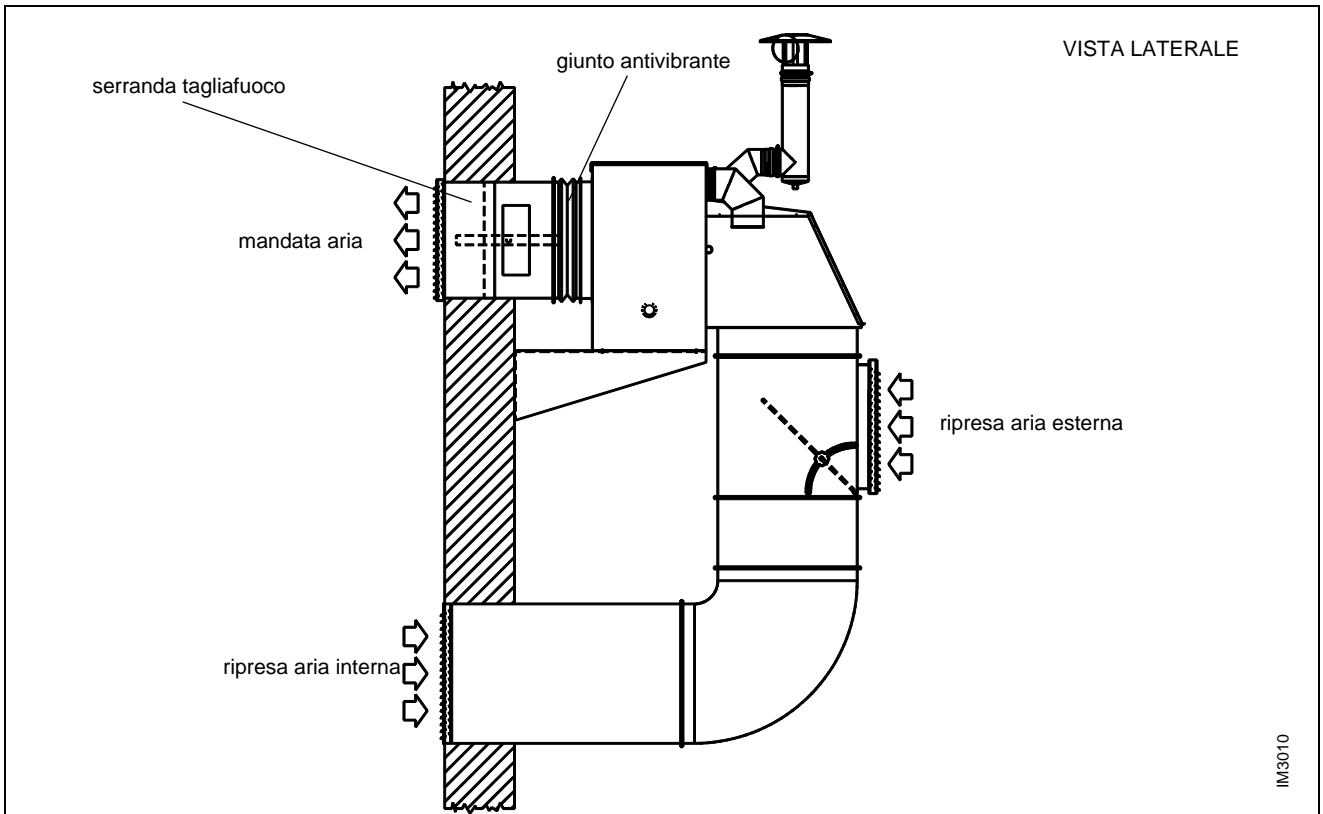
ESEMPIO DI INSTALLAZIONE A PARETE CON PARZIALE RIPRESA D'ARIA INTERNA
